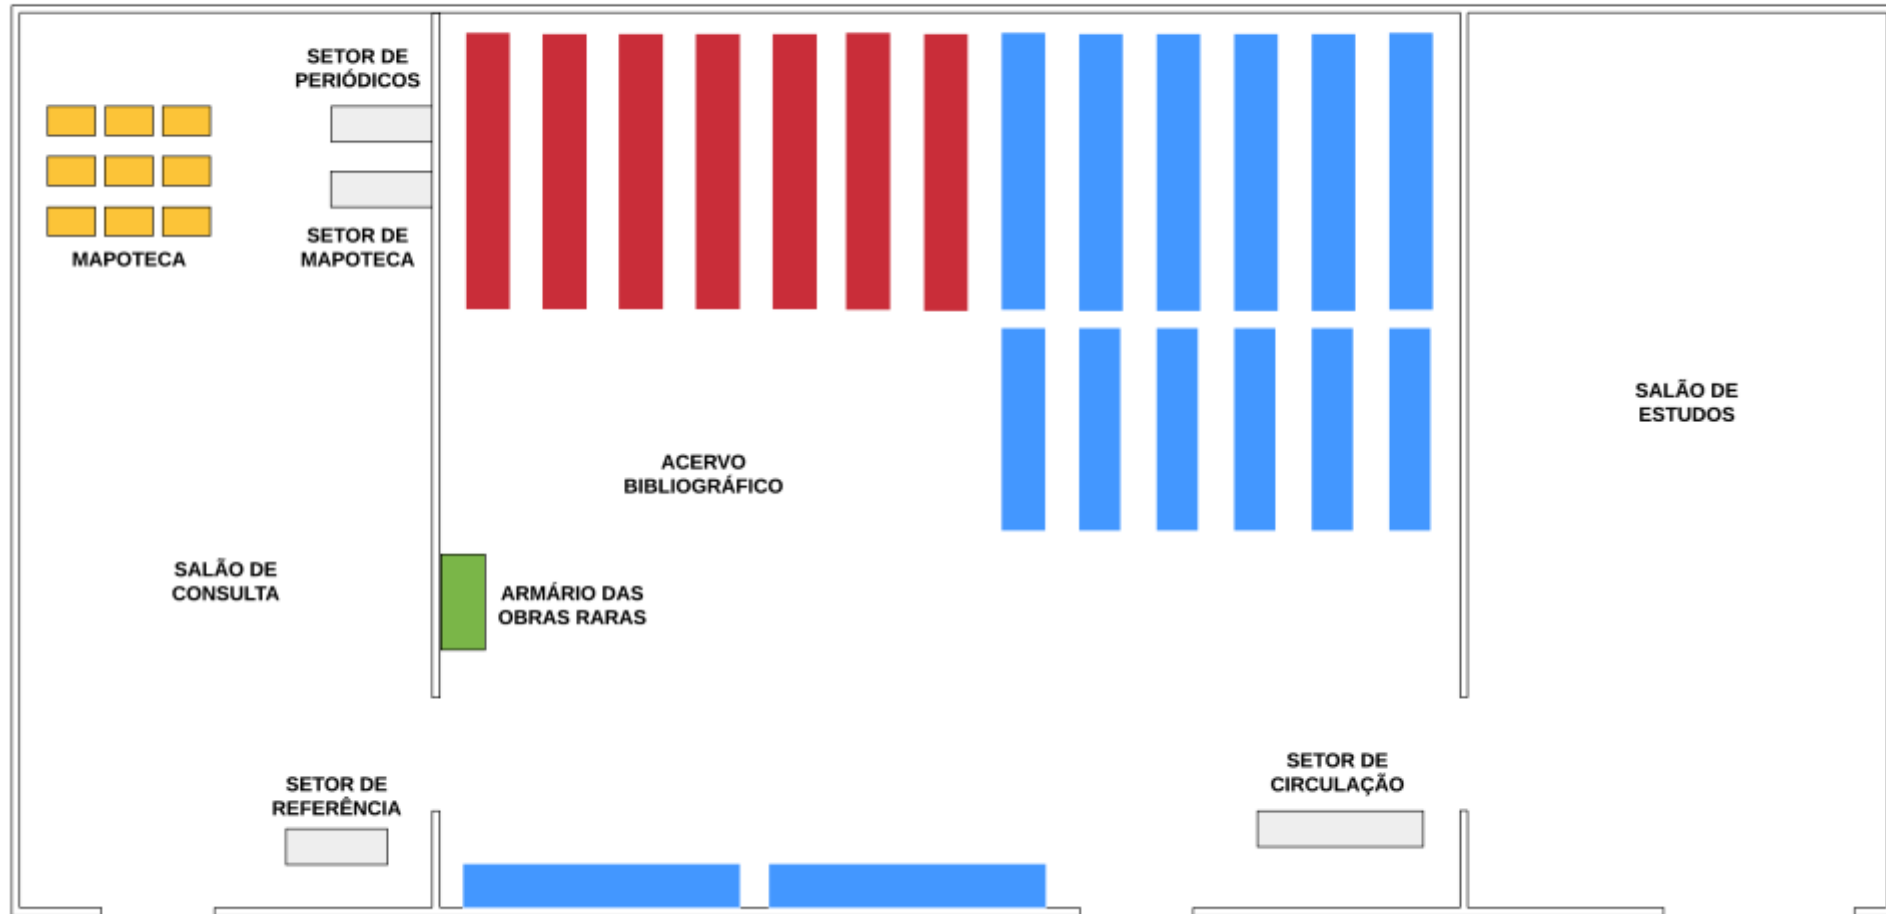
Planta baixa do pavimento da Biblioteca Central do CCMN
